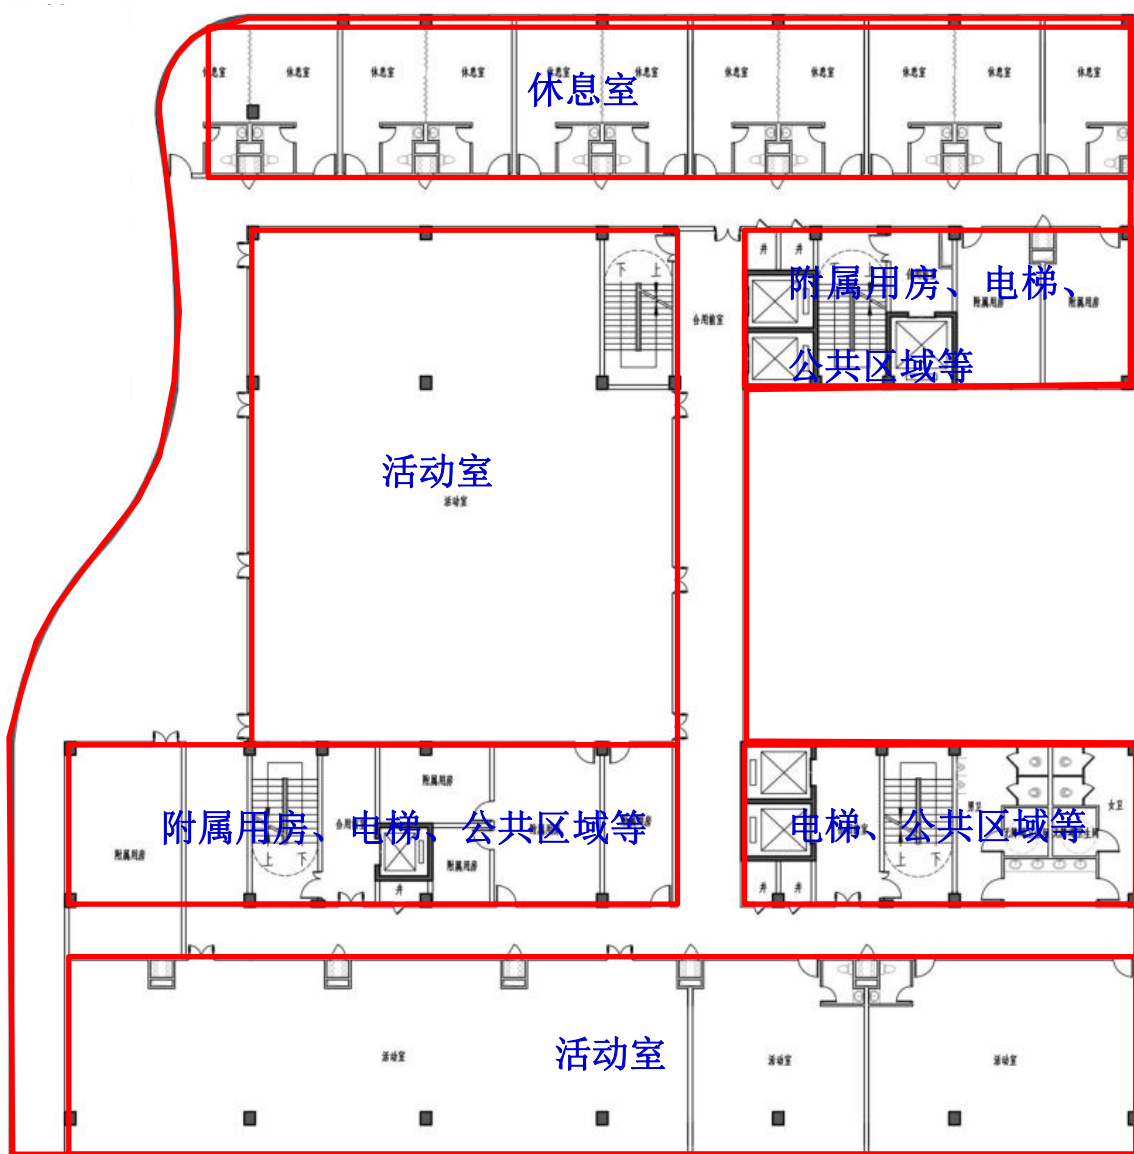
6#附属用房、8#自理楼三层平面图
